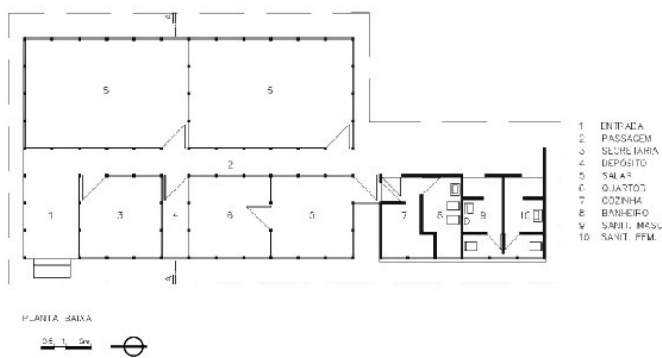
e 46 - Escolas pré-fabricadas | Planta 2 a 3 salas | plantas, 1965
